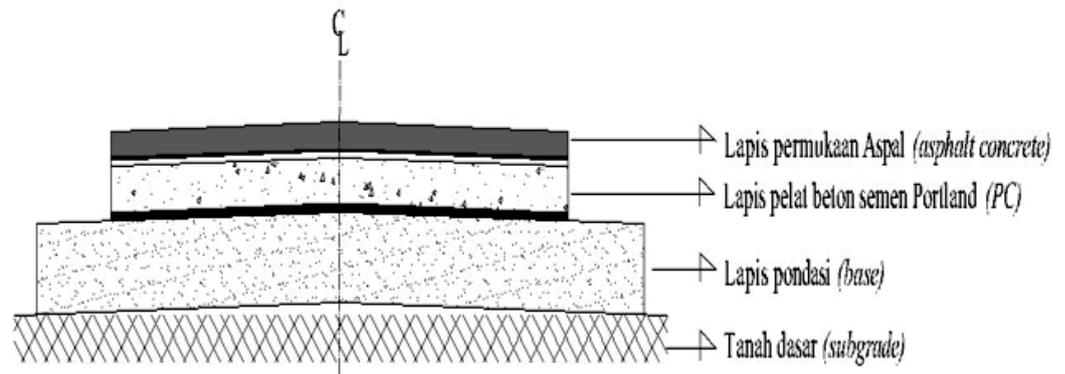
Struktur *Rigid Pavement* (Perkerasan Kaku)
